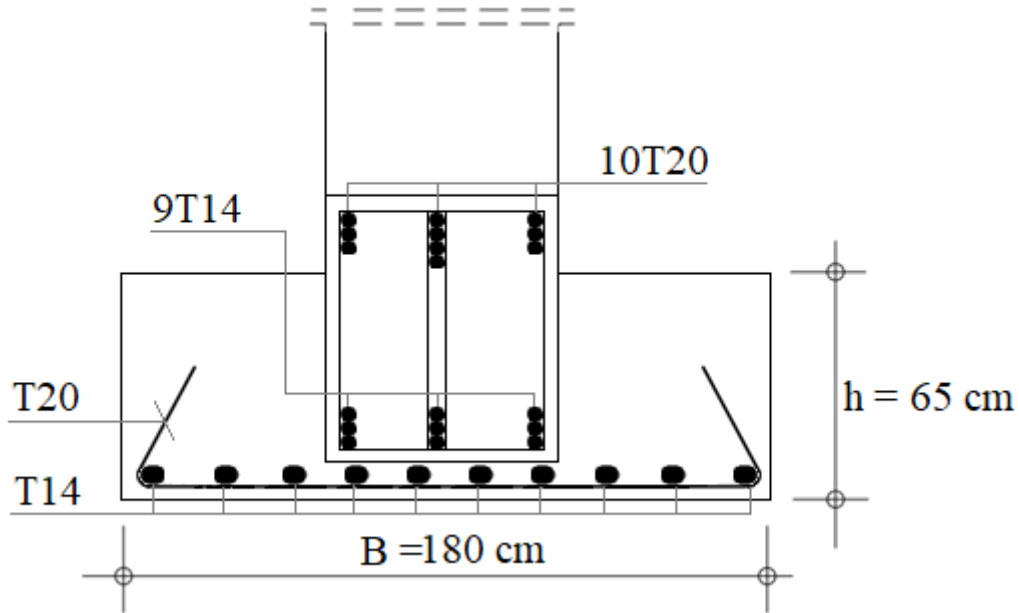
Ferrailage de semelle continue sous poteaux
